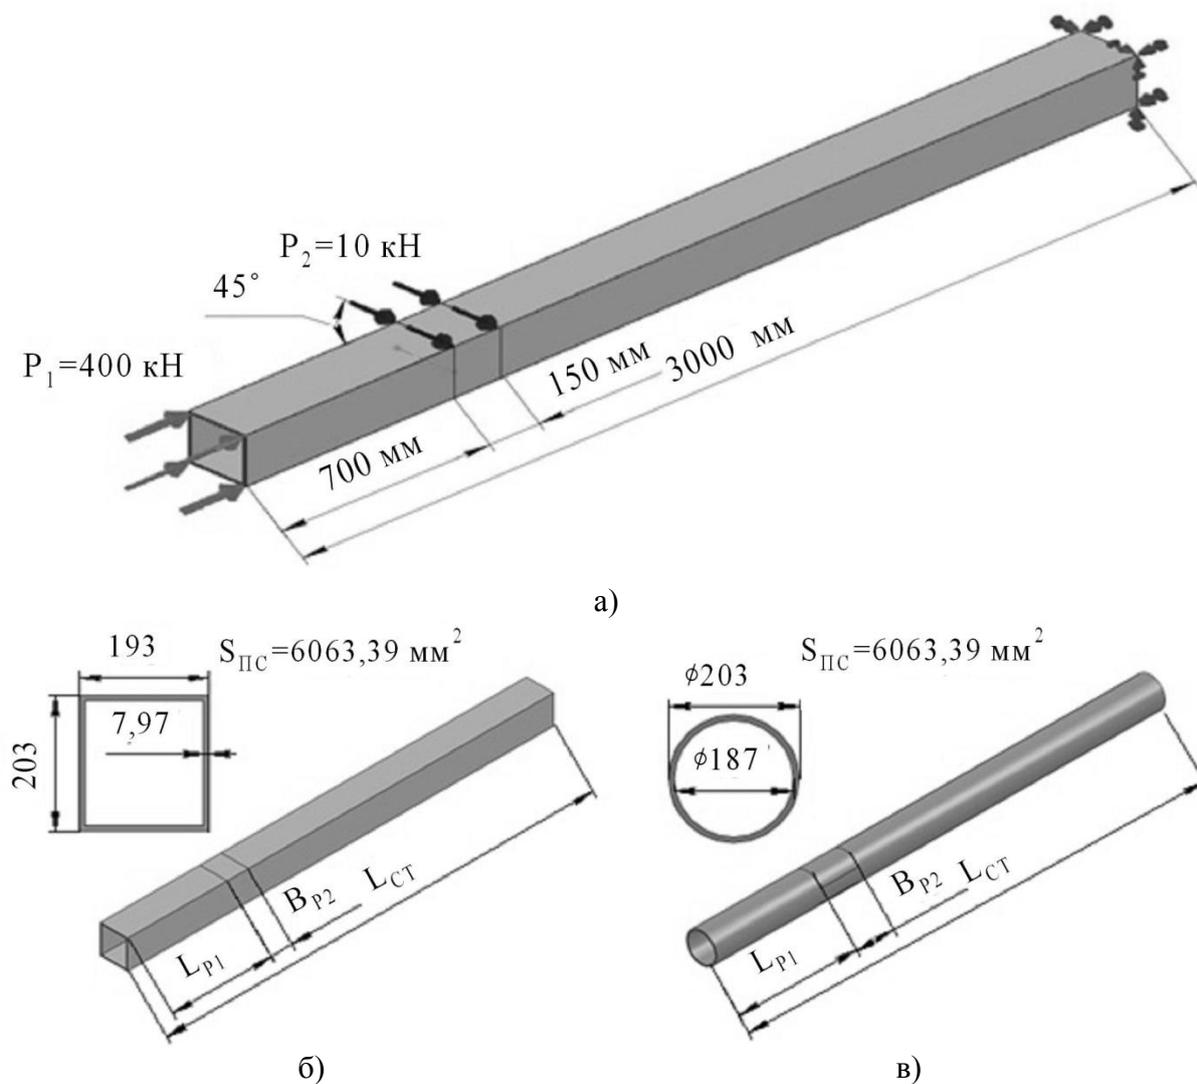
Схемы нагружения балок; а – общая схема; б - коробчатая балка; в - трубчатая балка.
